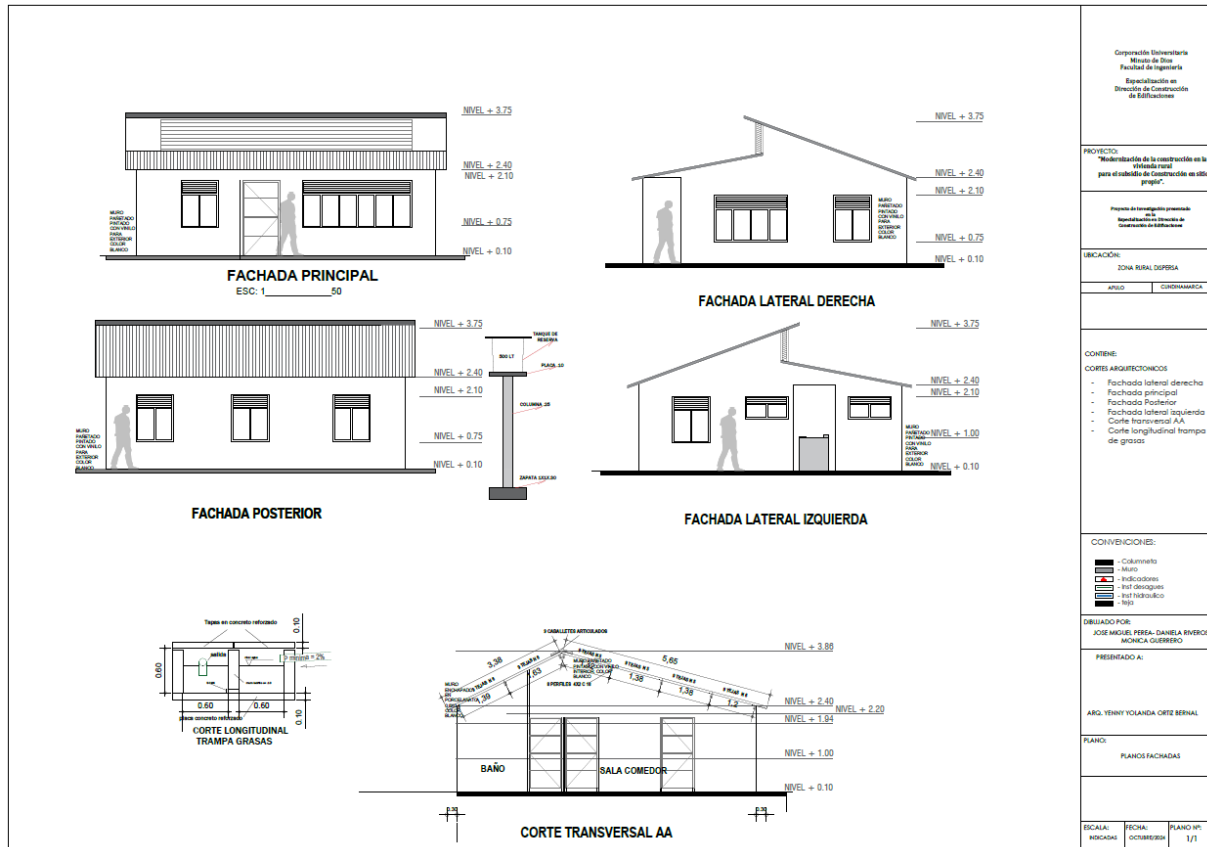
Plano fachadas cortes arquitectónicos. Fuente: Autores, 2024.
